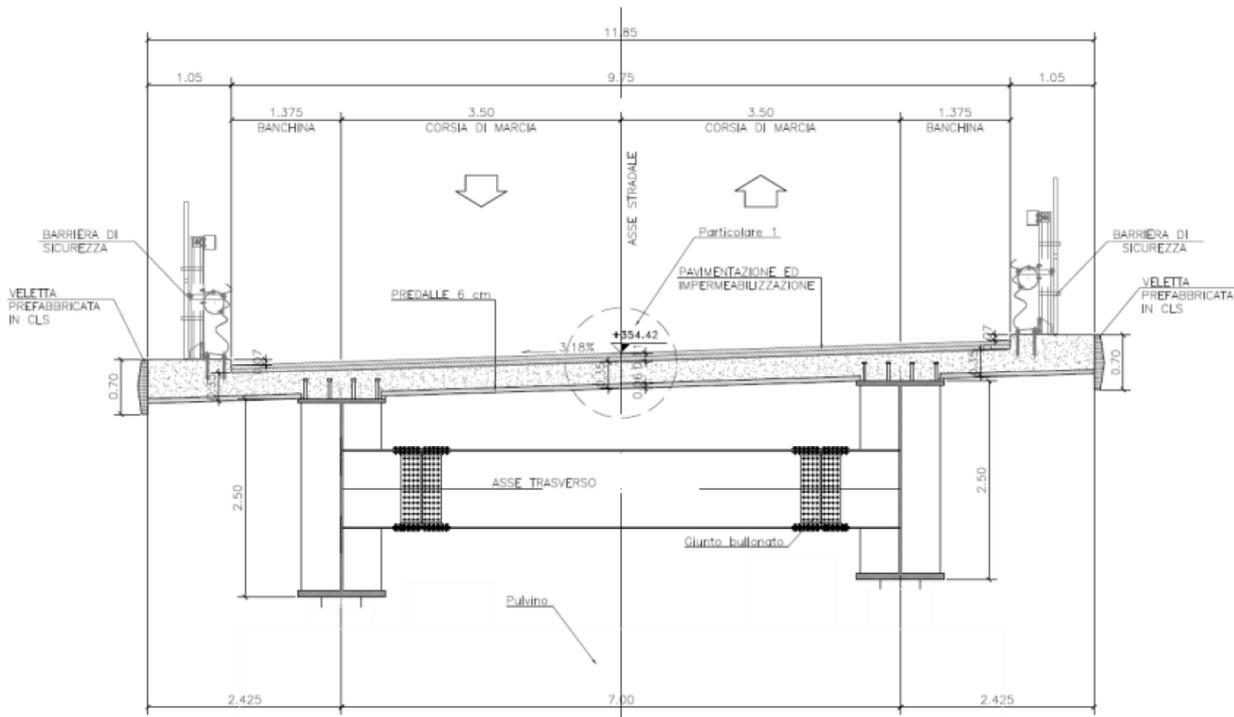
Sezione trasversale dell'impalcato del viadotto Molino Vecchio
